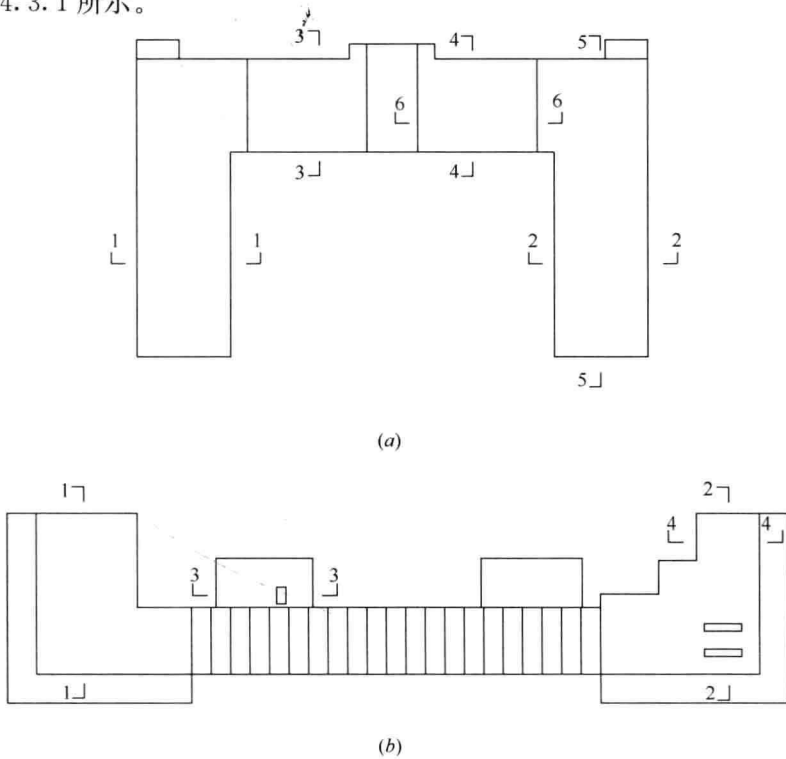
屋面积雪深度实地测量目标建筑平面示意图
